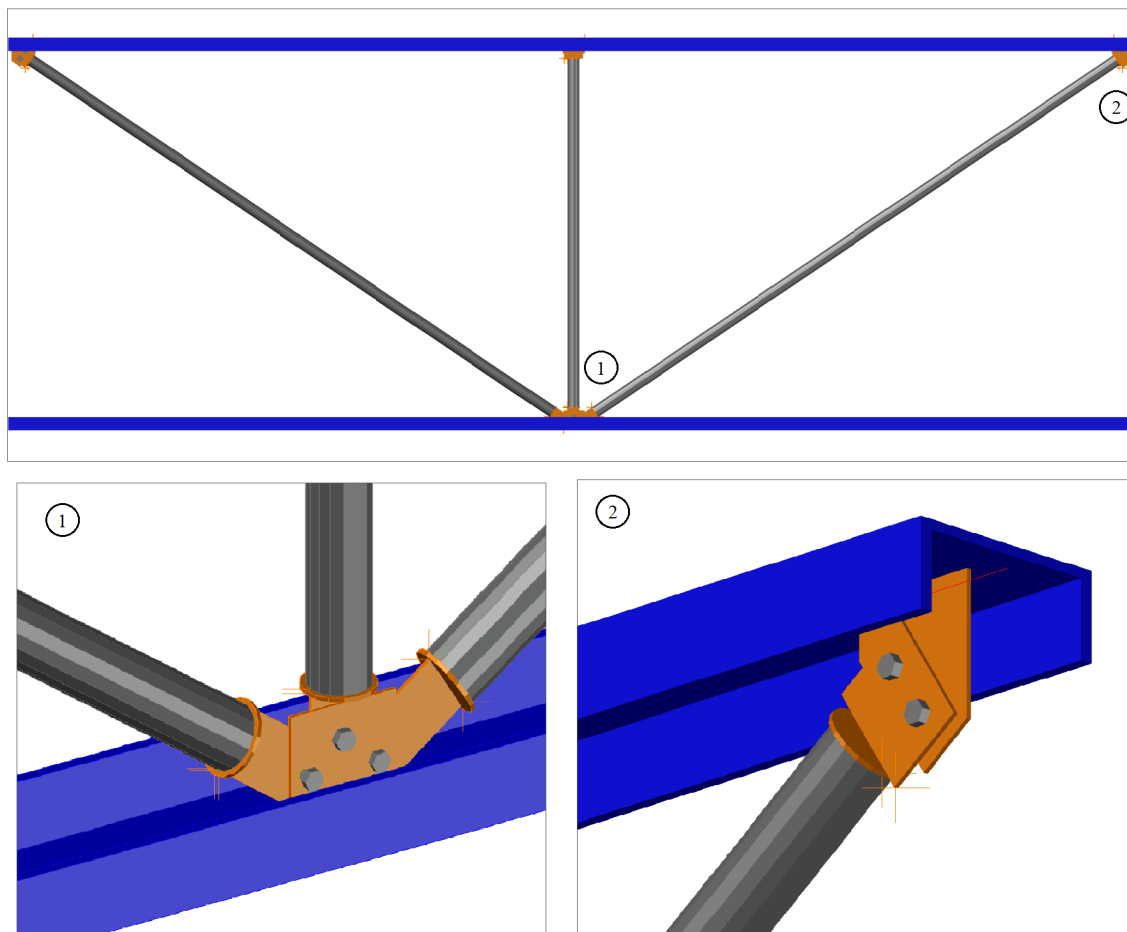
Ligações aparafusadas nos elementos de contraventamento das madres.
